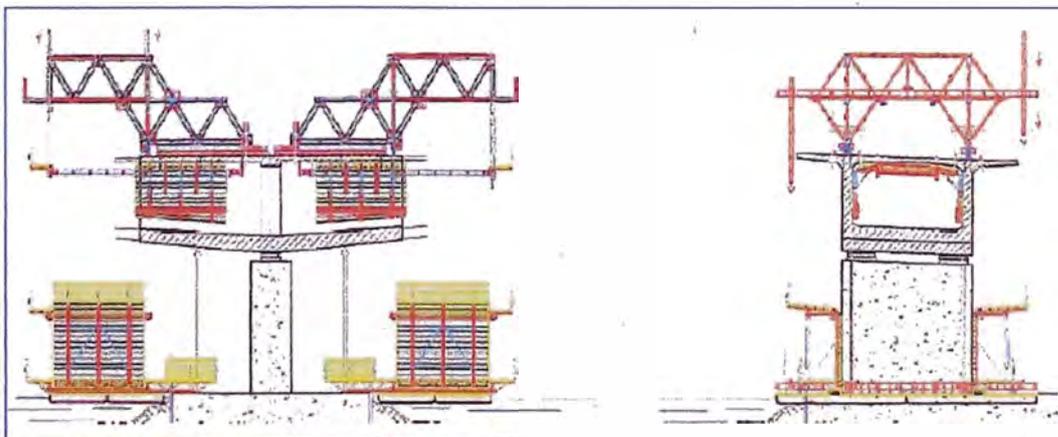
Esquema del pre montaje del encofrado de fondo
